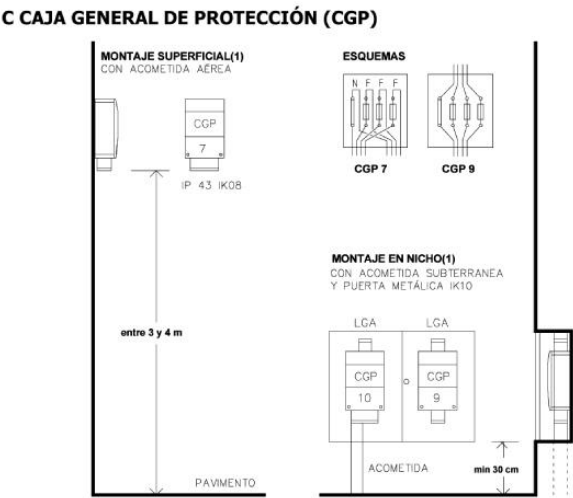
Caja General de Protección (Fuente: REBT)
